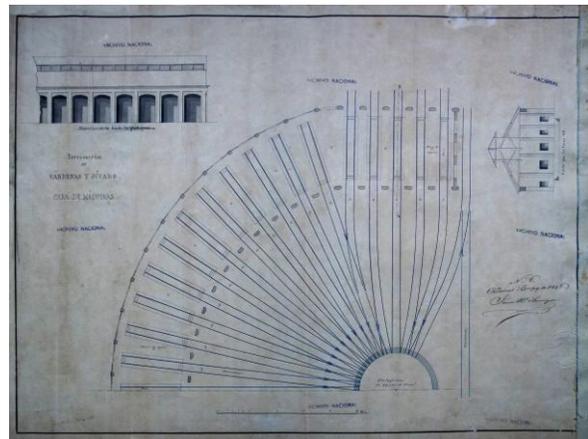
Plano de la casa de máquinas del Ferrocarril de Cárdenas y Júcaro. Fuente: Archivo Nacional de Cuba.
